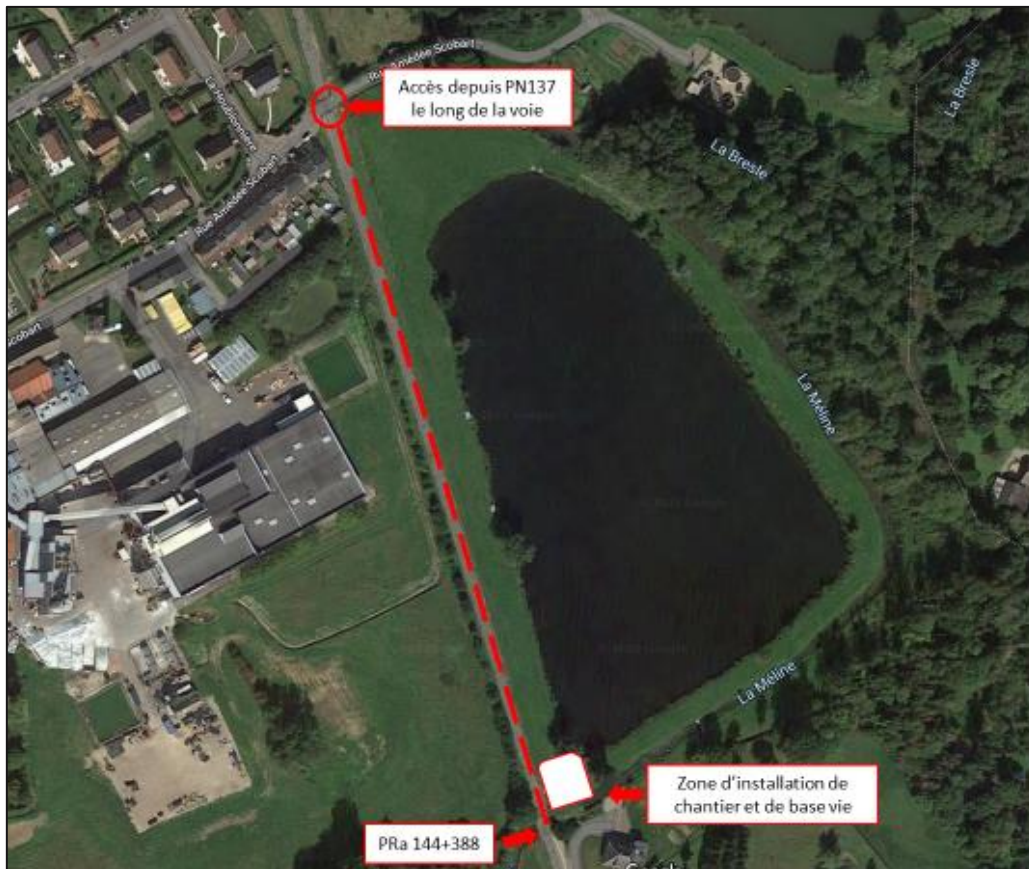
Ligne 325 000 – Zone d'installation de chantier et accès – PRa 144+388
